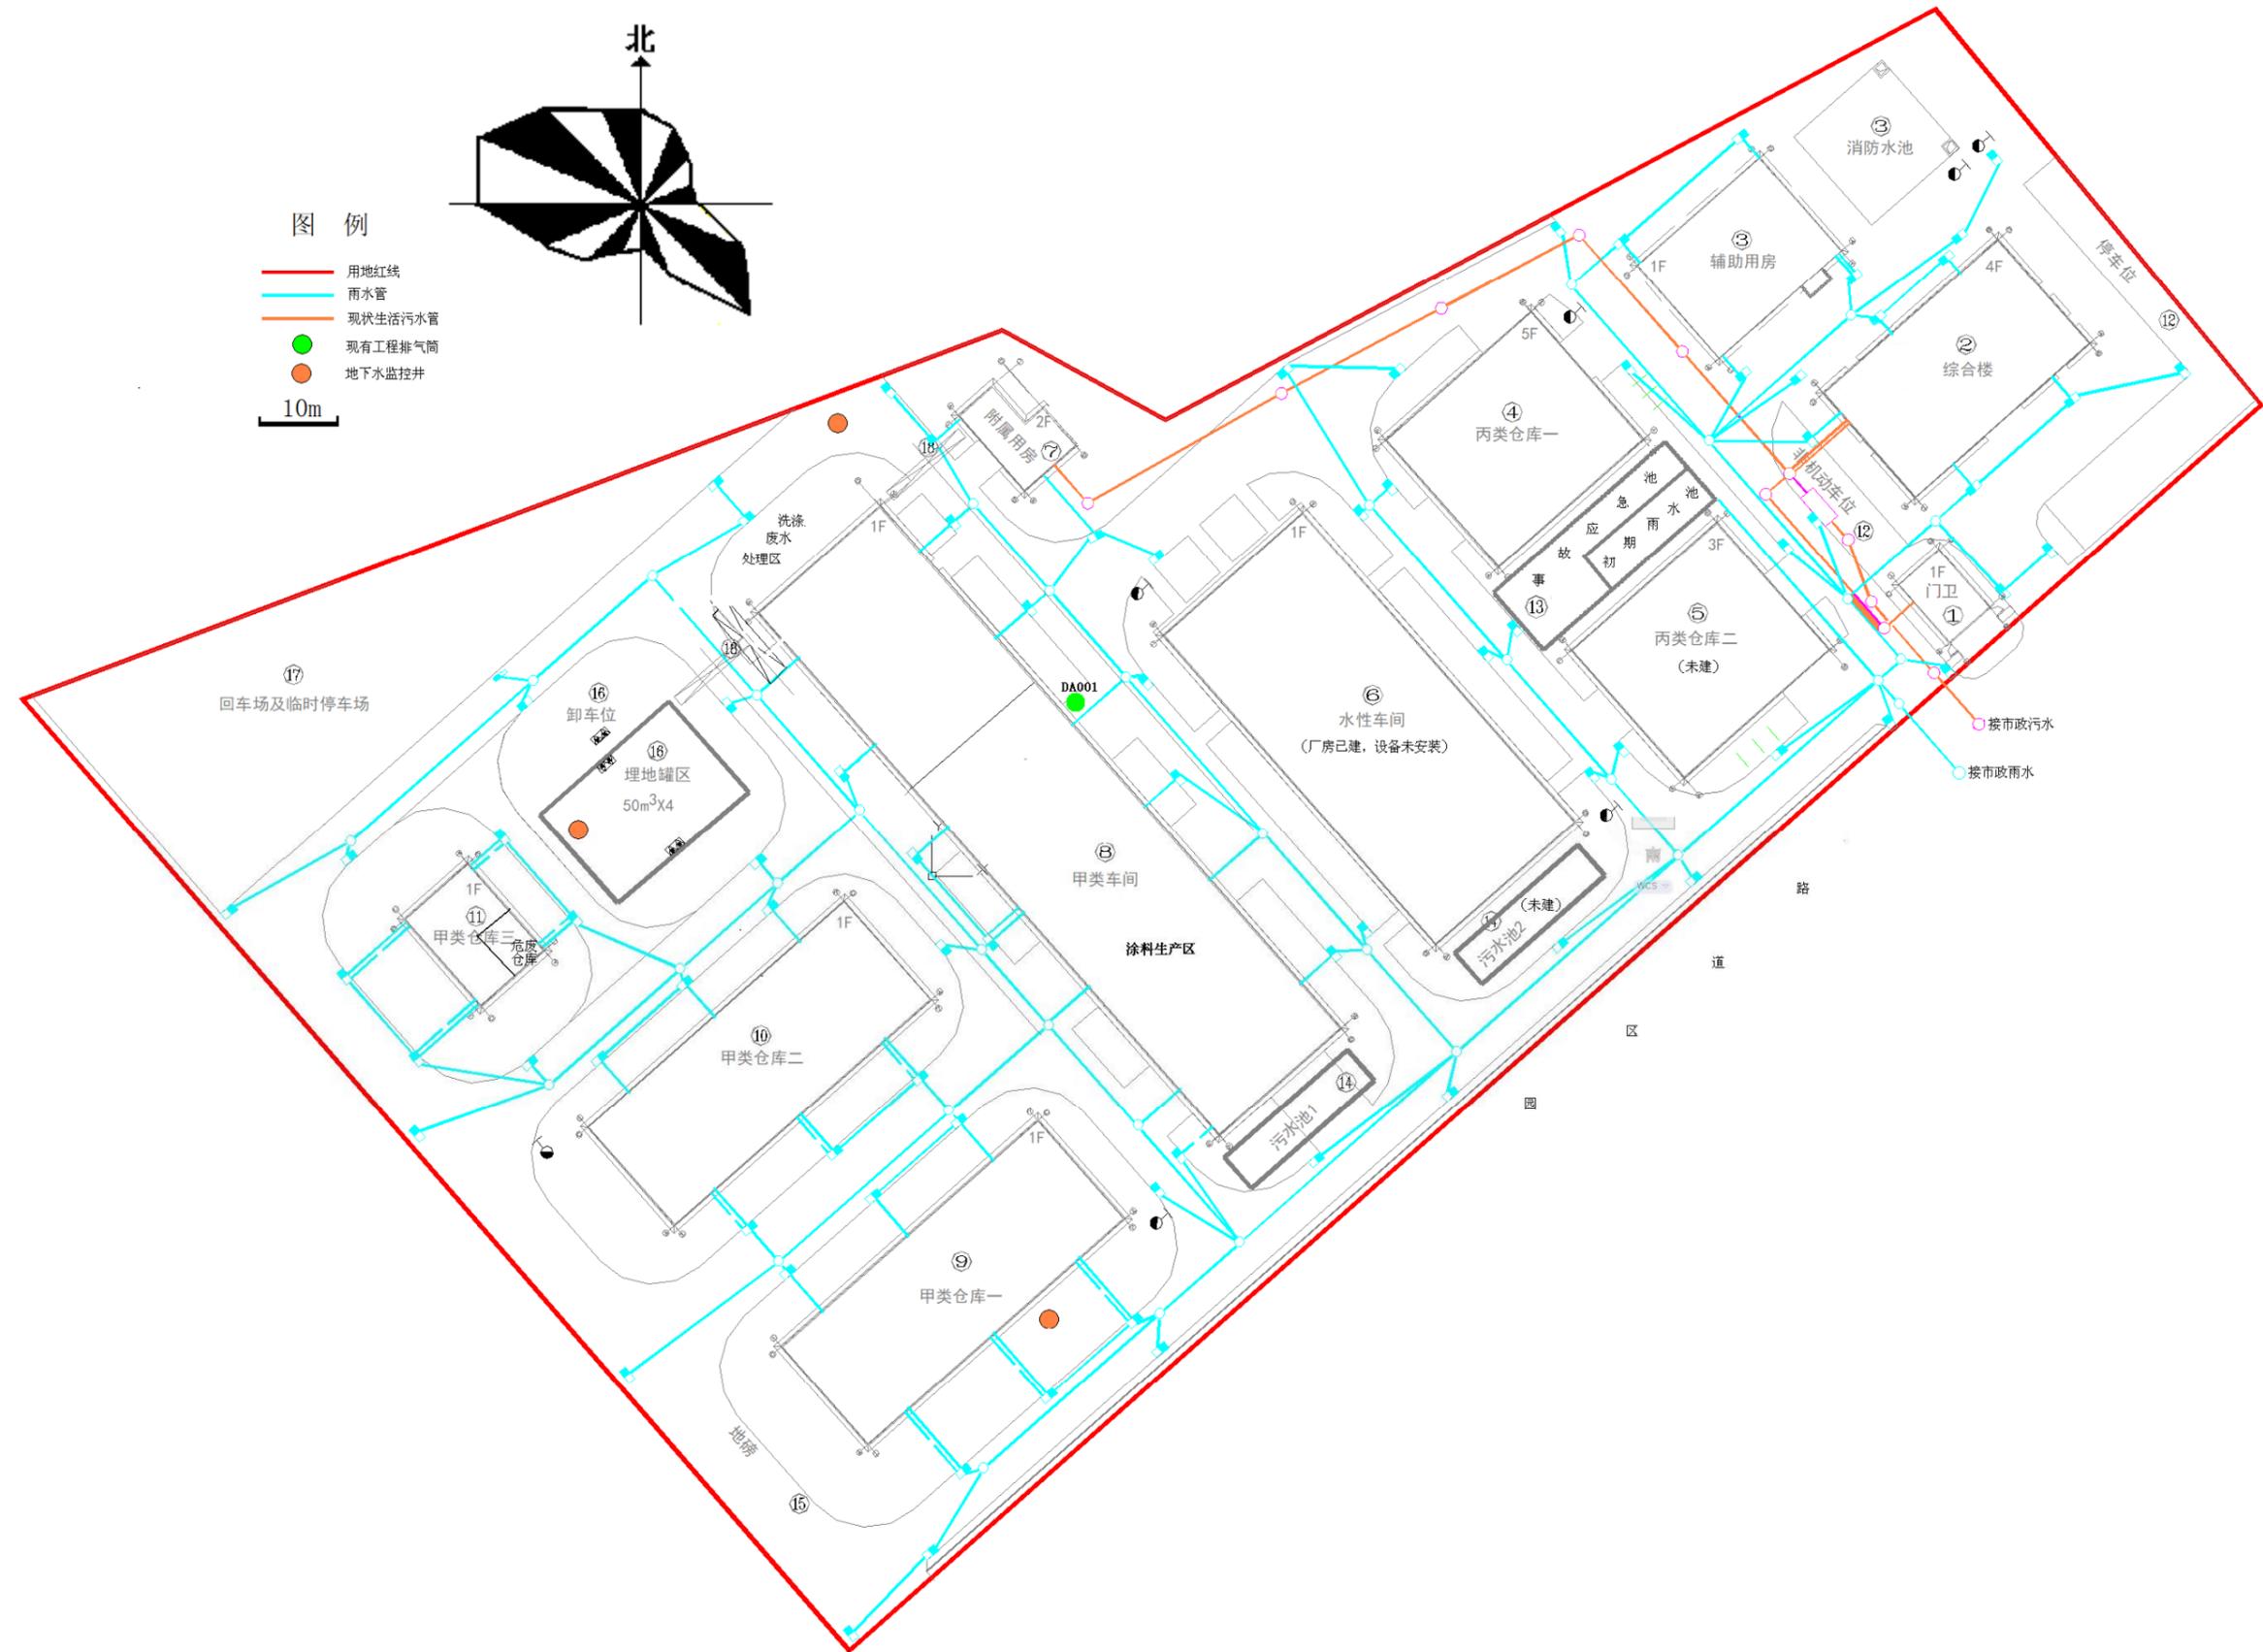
现有工程平面图（含雨水、污水管网图）
